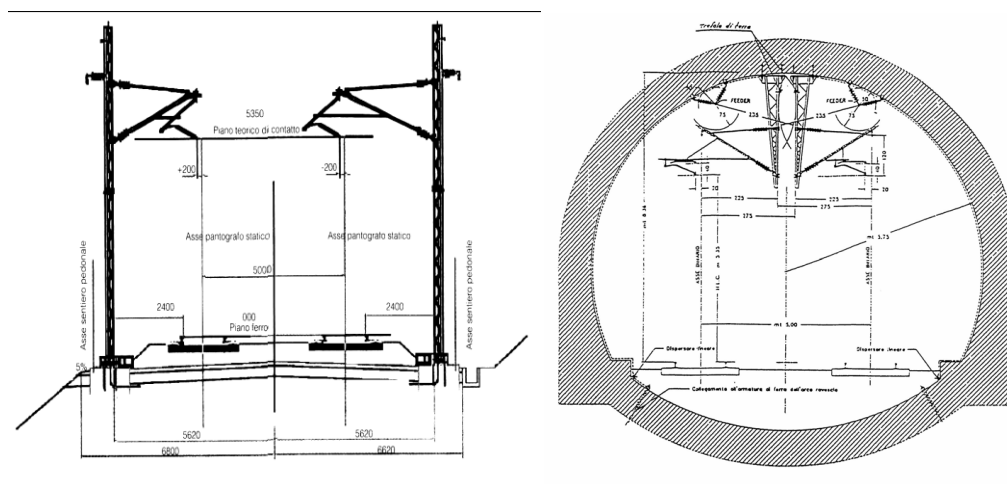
Sezione trasversale all'aperto e in galleria
